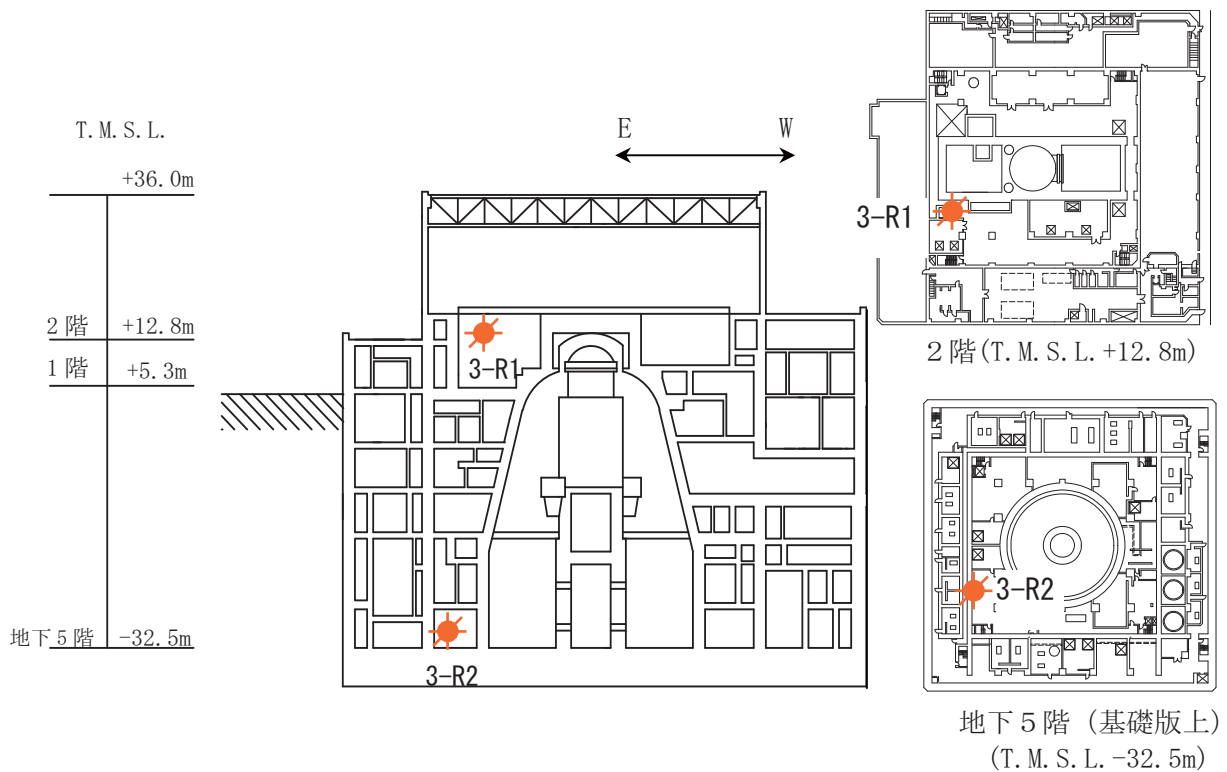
3号機原子炉建屋地震計配置図 (赤星部)
